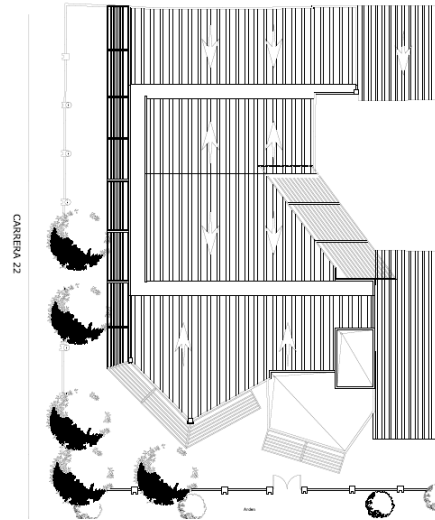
Planta de Cubiertas. CAJAMAG.
